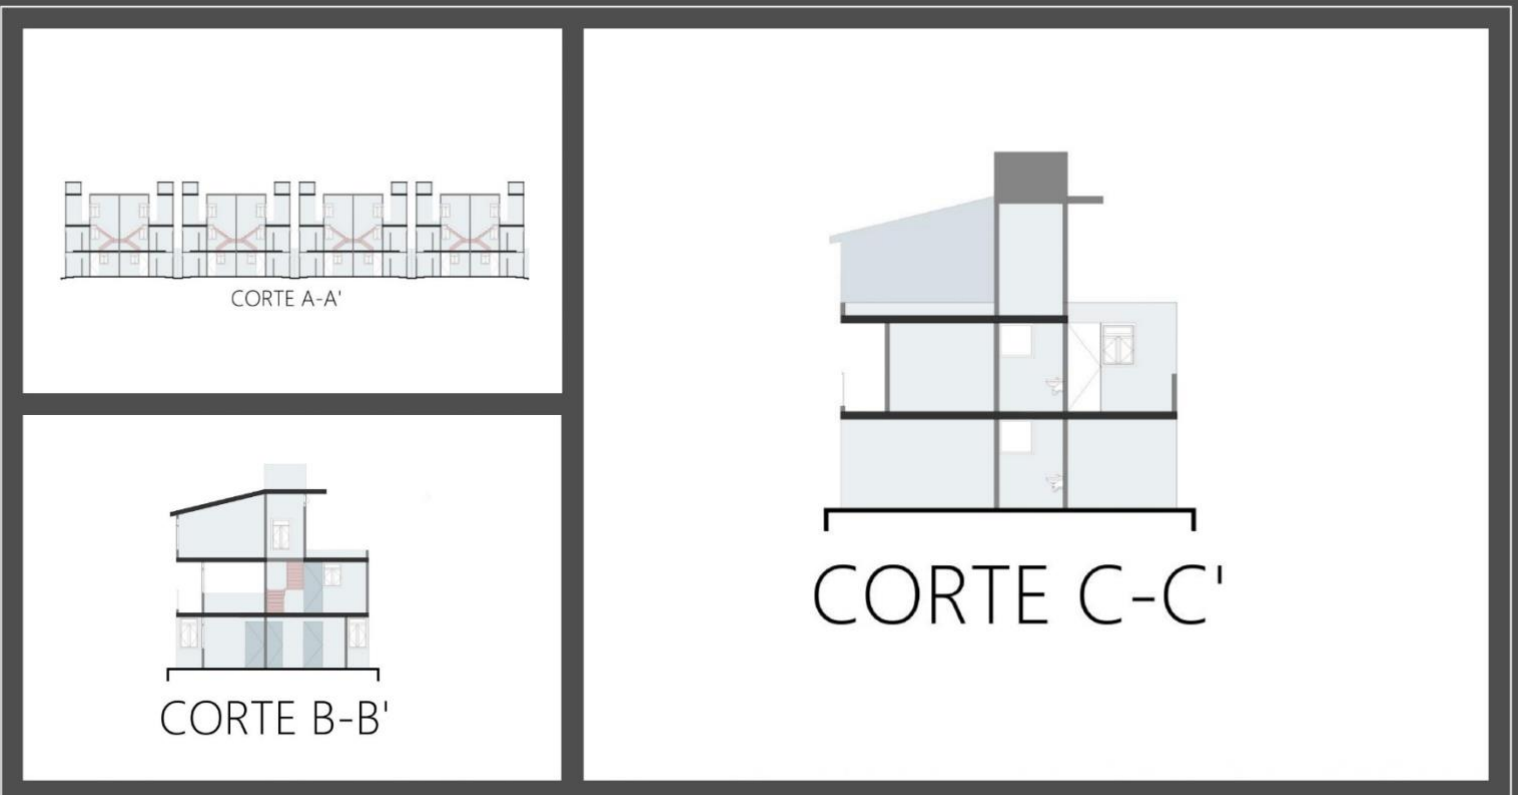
Cortes arquitectónicos – Proyecto Palo Alto
